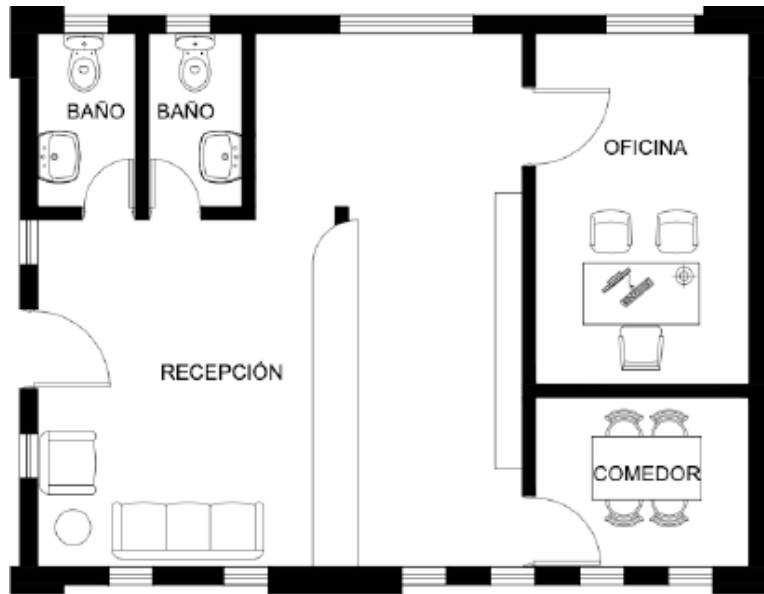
Plano de la planta arquitectónica de la caseta de información turística.
